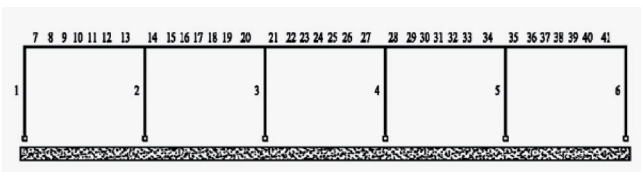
Рамная схема фундамента коксовых батарей с боковым подводом отопительного газа.
